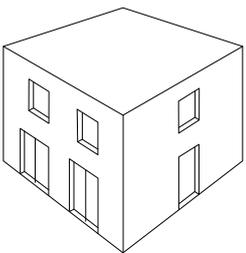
Vergleichsobjekt (Bruttogeschossfläche: 162 m², konditioniertes Volumen: 405 m³), Quelle: Zuschnitt Attachment: Gebäudezertifizierung und nachhaltiges Bauen, proHolz Austria 2010
